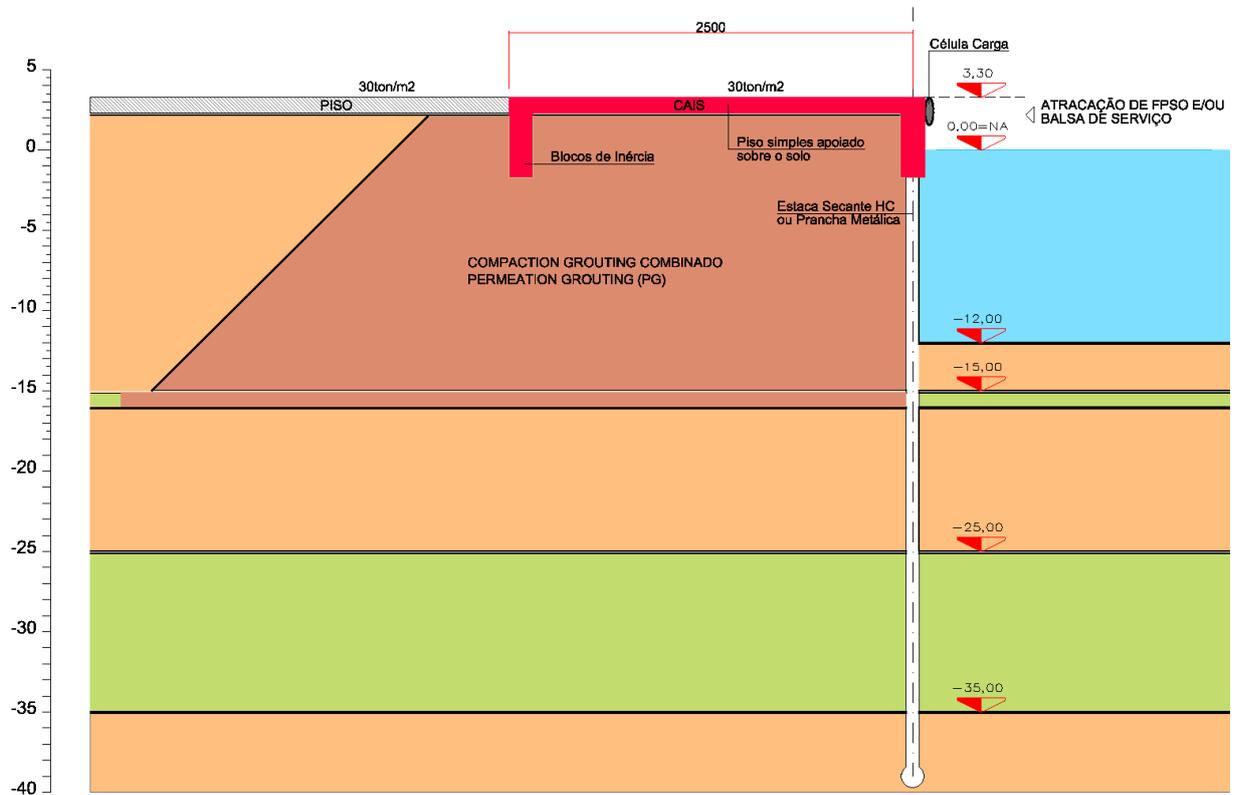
B– Opção B - Estrutura do cais, corte transversal – Permeation Grouting
